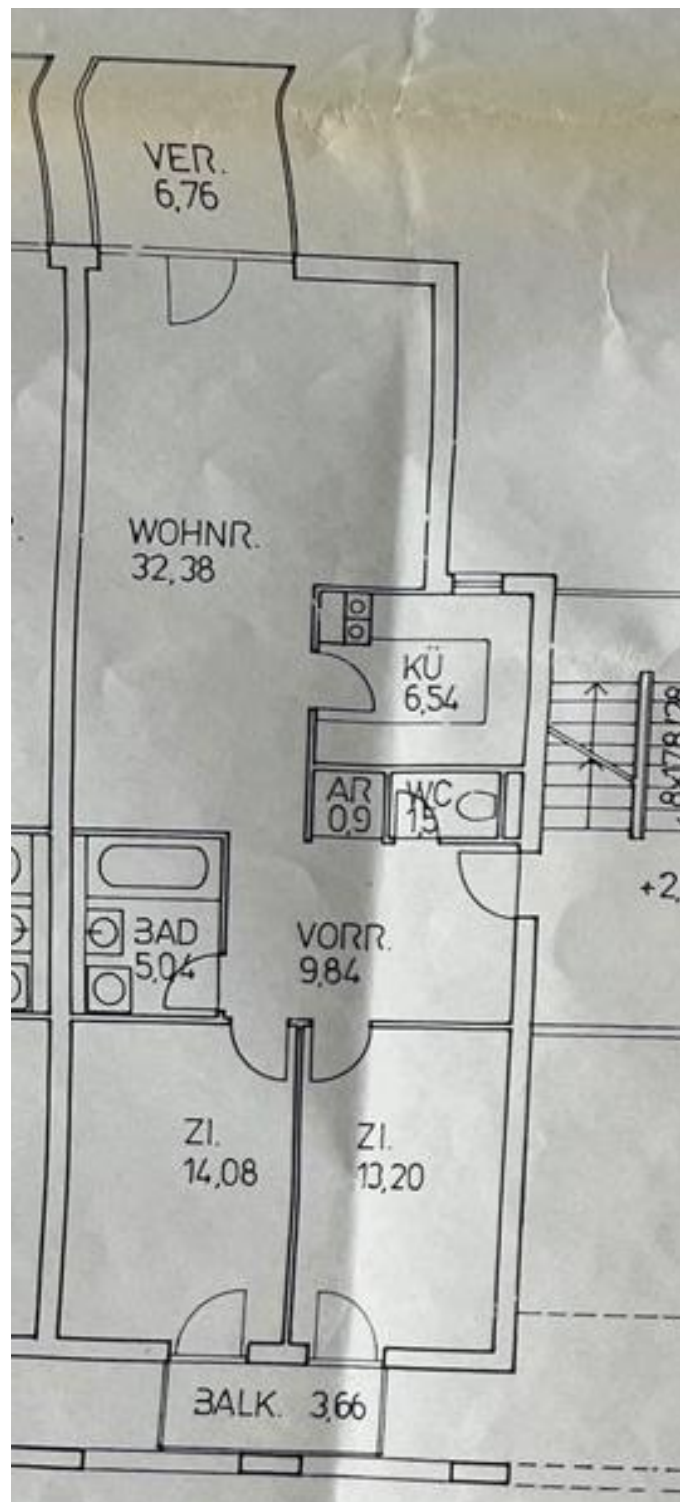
Grundriss Wohnung Top C17 (Einreichplan, v. 13.12.1990)
